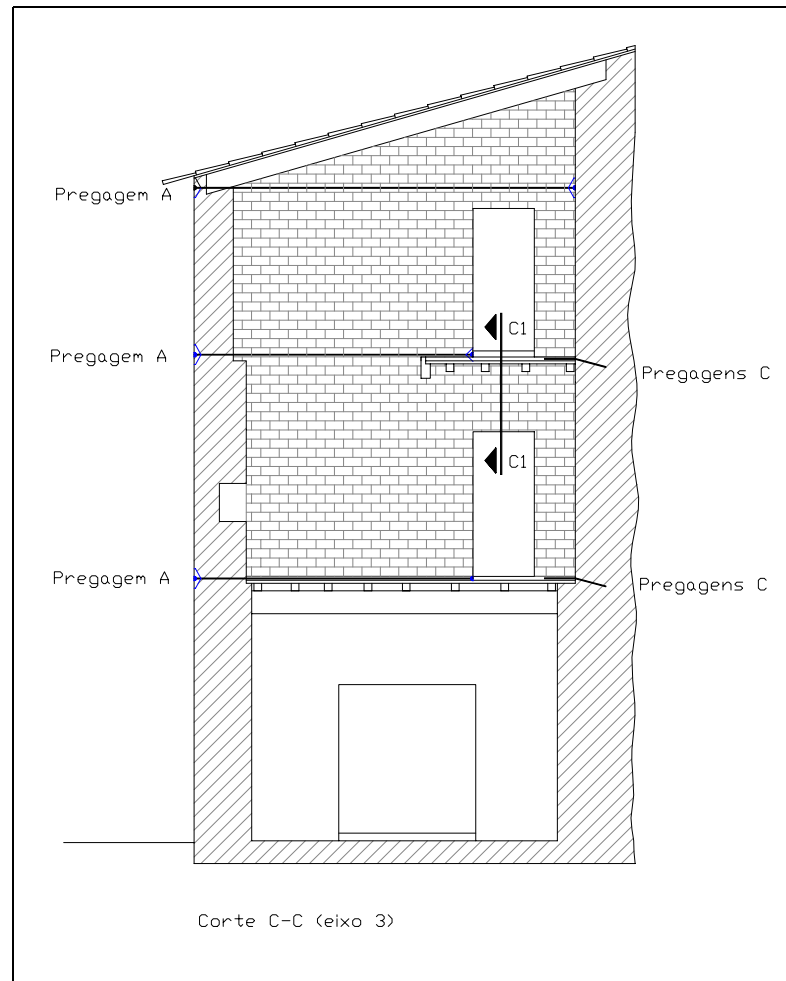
Parede transversal de contraventamento. Pregagens empena-contraventamento.
